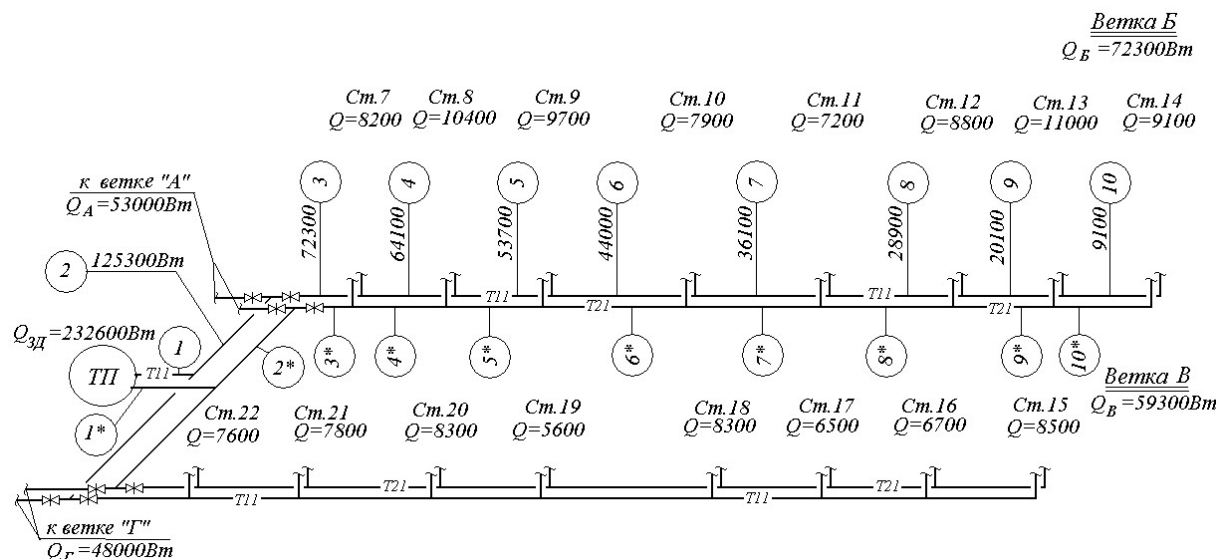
Схема системы теплоснабжения стояков двухтрубной вертикальной системы отопления с нижней разводкой магистралей
